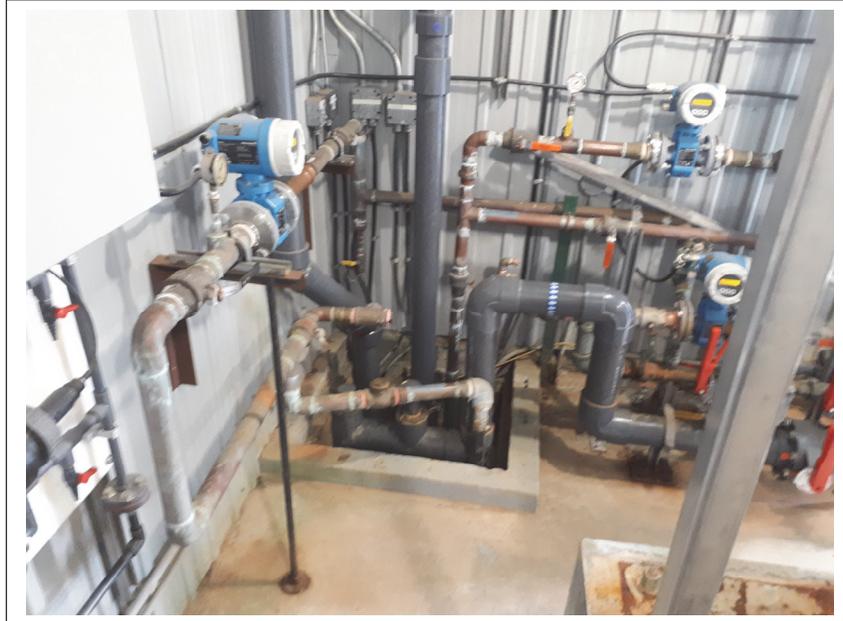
Vue générale de la canalisation associée aux trois puits du secteur Les Buissons – 2020-05-21
